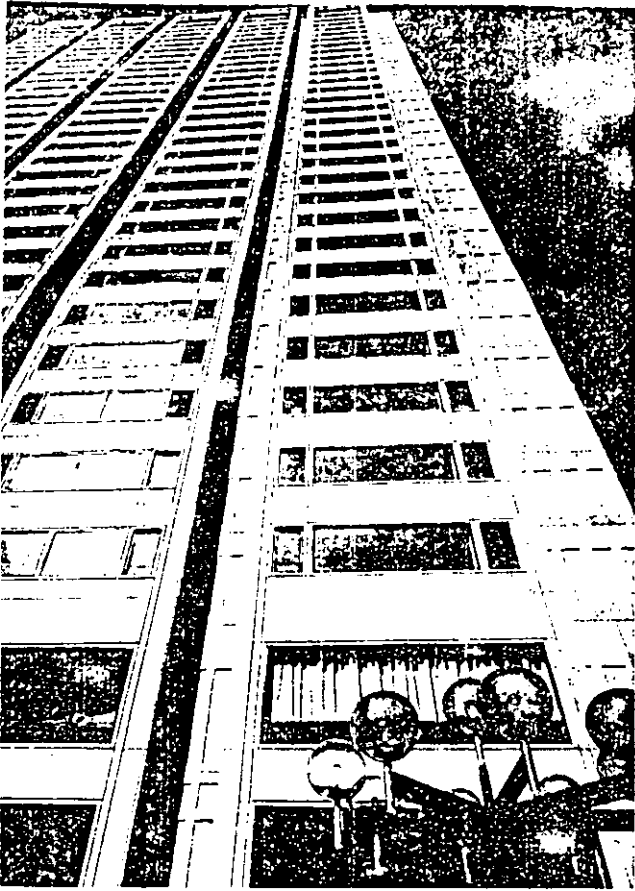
ELEMENTOS PREFABRICADOS UTILIZADOS COMO ENCOFRADO EN MURO HUECO
